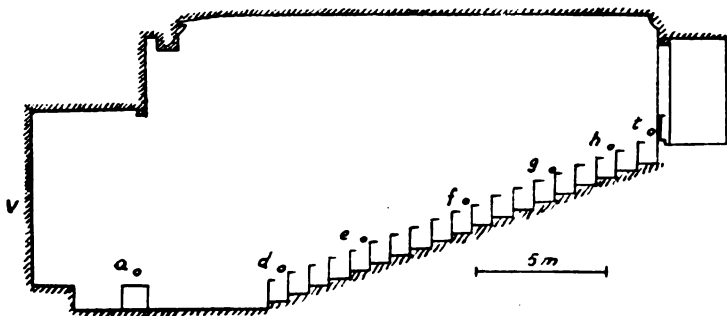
Sezione dell'aula di lezioni della fig. 17.
